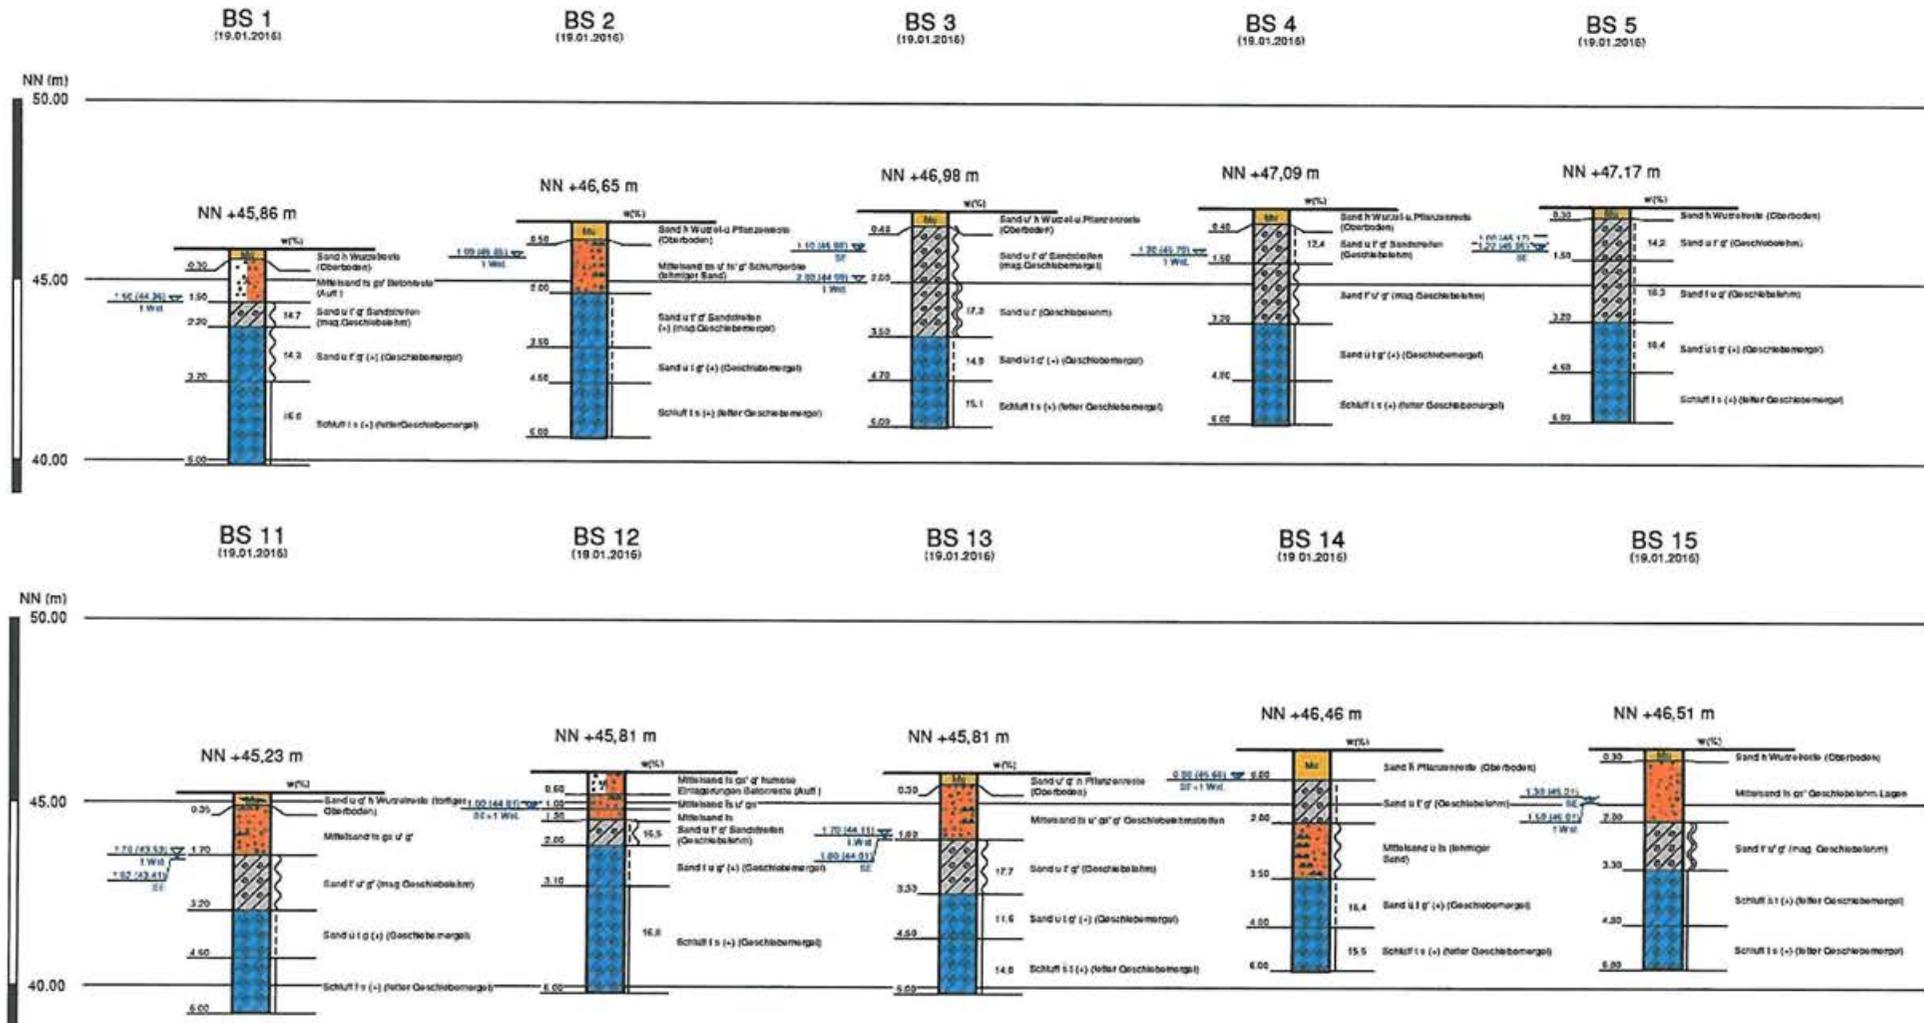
Auszug aus der Baugrunduntersuchung mit exemplarischer Darstellung einiger Baugrundaufschlüsse – Bohrprofile
